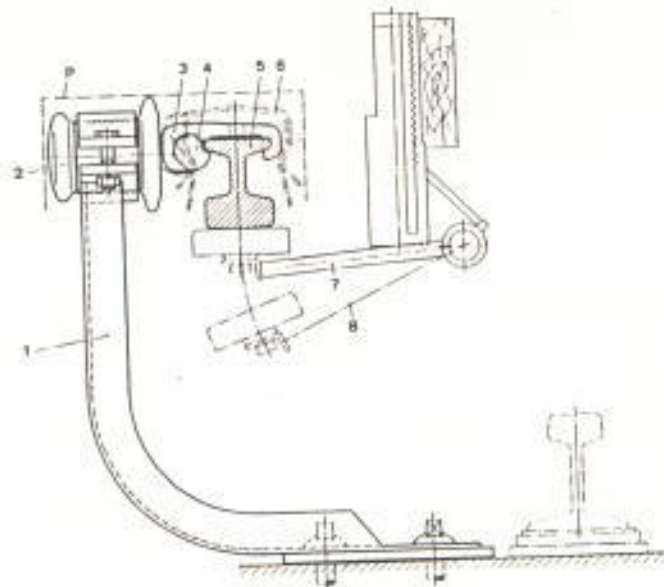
PUNTO DE APOYO DEL CARRIL DE
